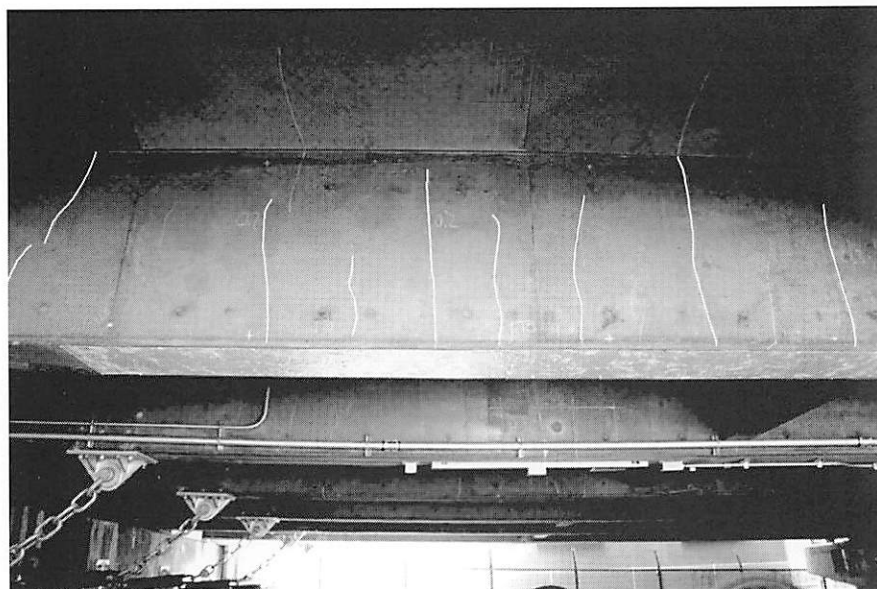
主桁の橋軸直角方向のひび割れ
